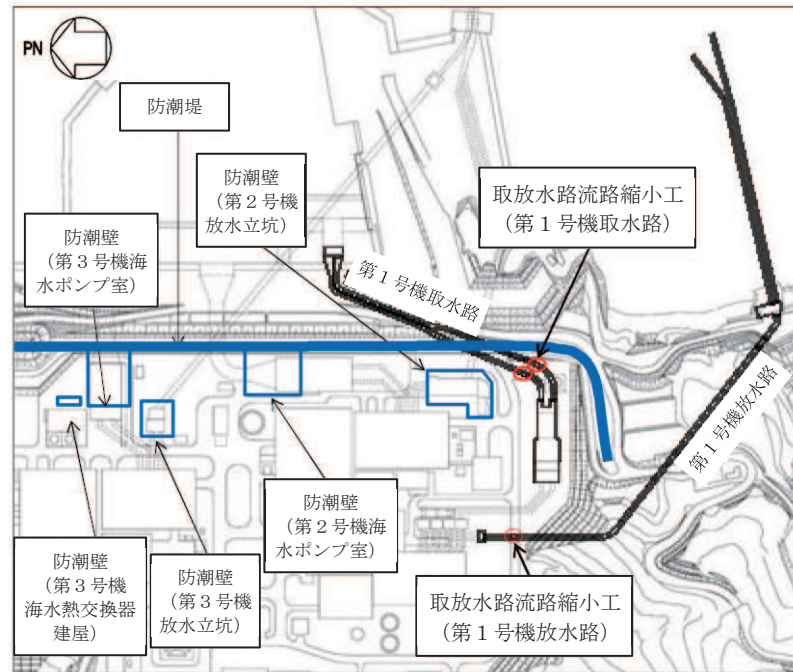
取放水路流路縮小工（第1号機放水路）の位置図（全体平面図）
